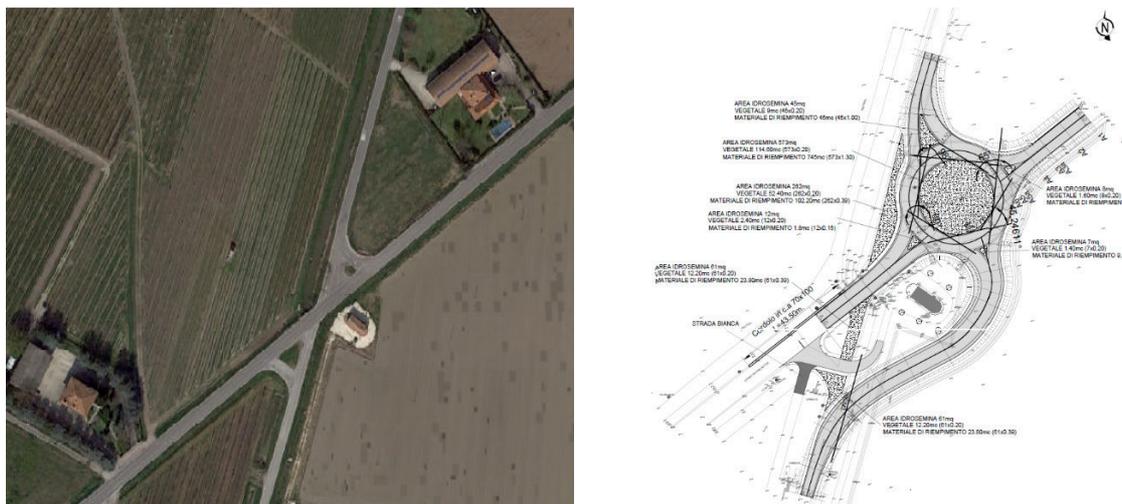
confronto stato attuale (v. ortofoto a sx) e planimetria di progetto (vedi planimetria a dx). Fonte: Allegato 3 alla Lista di controllo
